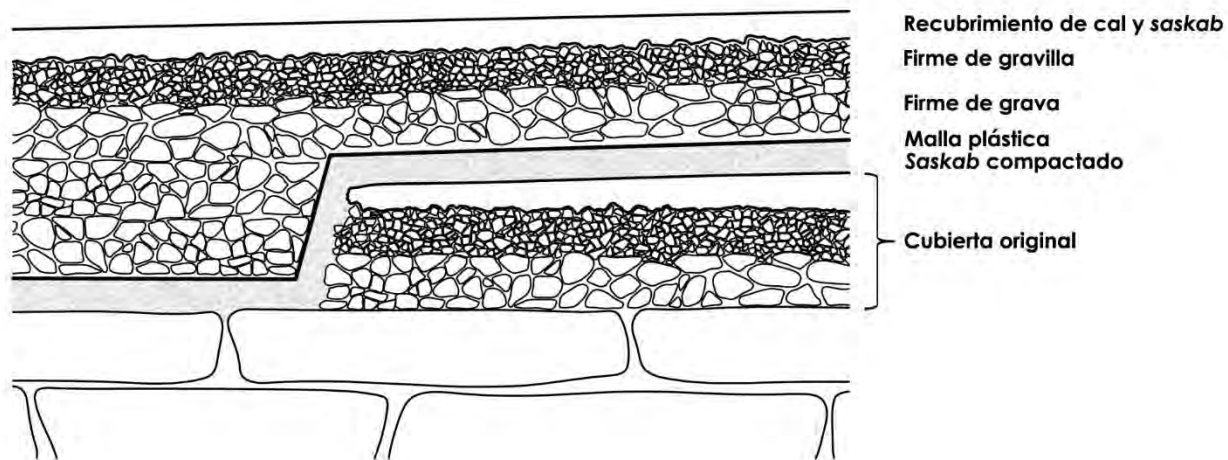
Corte esquemático de la propuesta de la cubierta de sacrificio.
